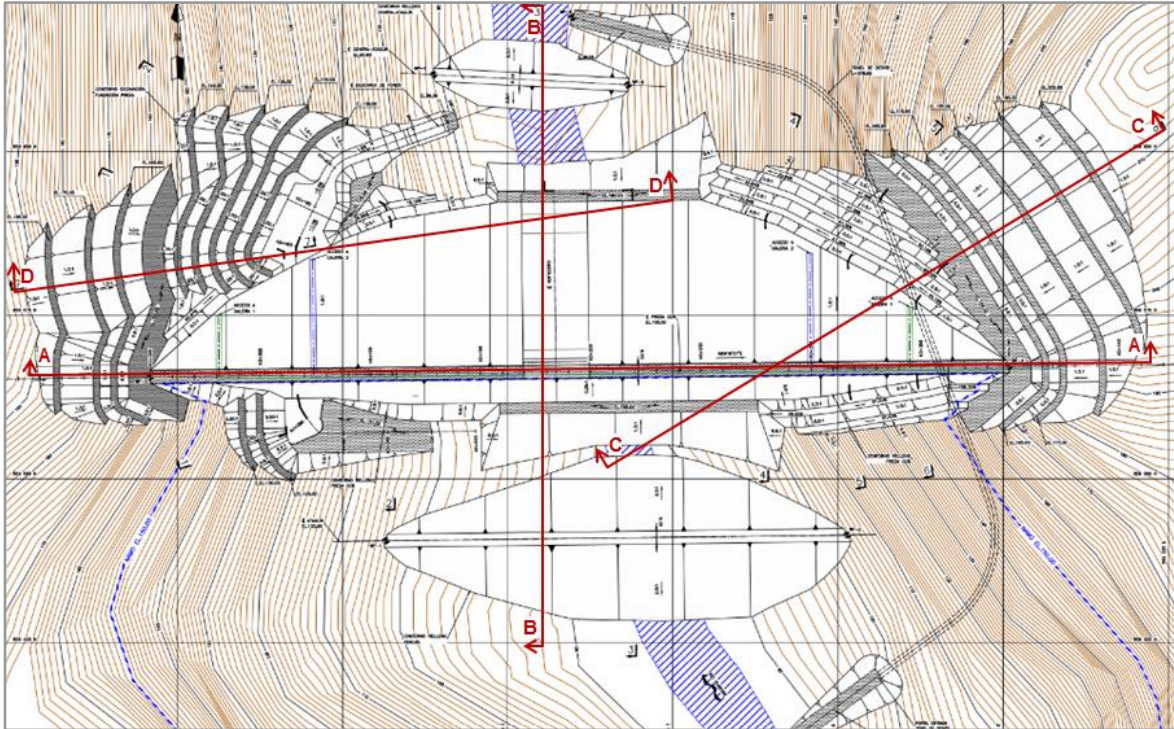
Ubicación en planta, secciones analizadas en Slide.
